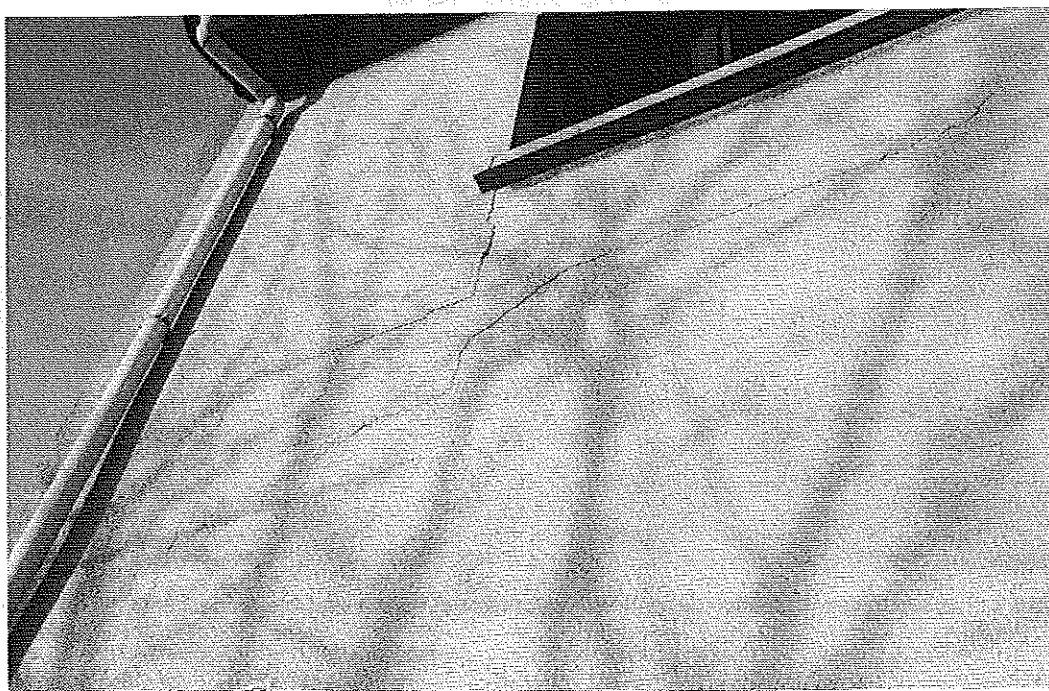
Détail partie haute de l'angle façade. Fissures horizontale et verticale raccordée à la baie. © J. Putatti
